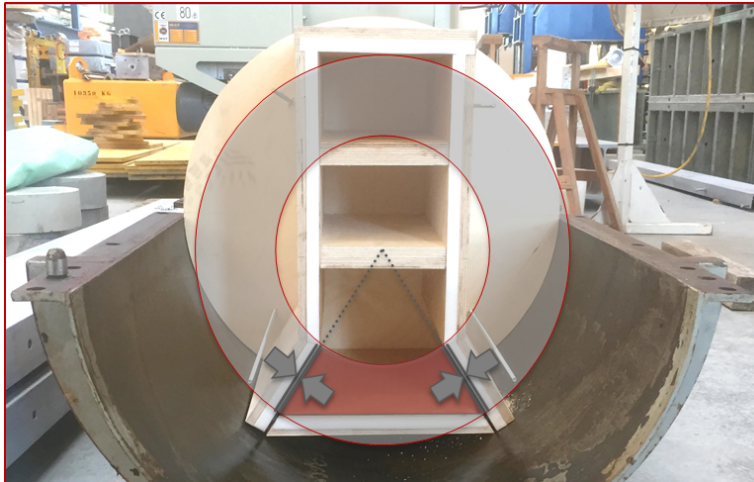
Gleichgewichtszustand von Vollrohrquerschnitt zu Segmentquerschnitt
